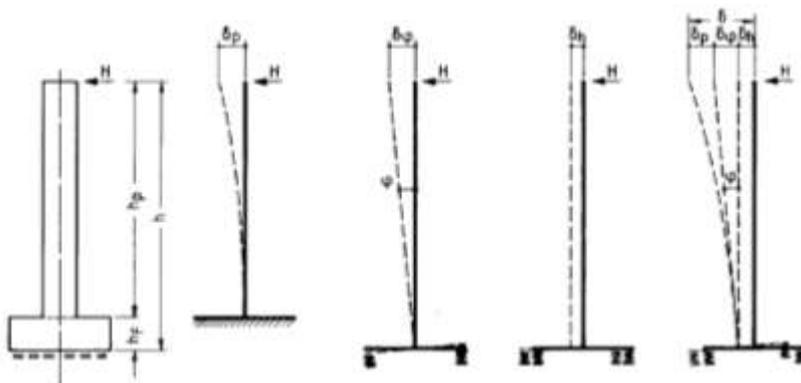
Rigidité longitudinale équivalente sur la structure d'appui
